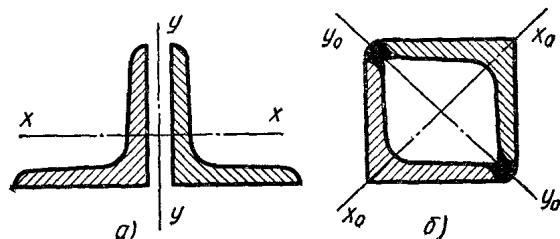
Уголки (а) и профиль (б), полученный сваркой
